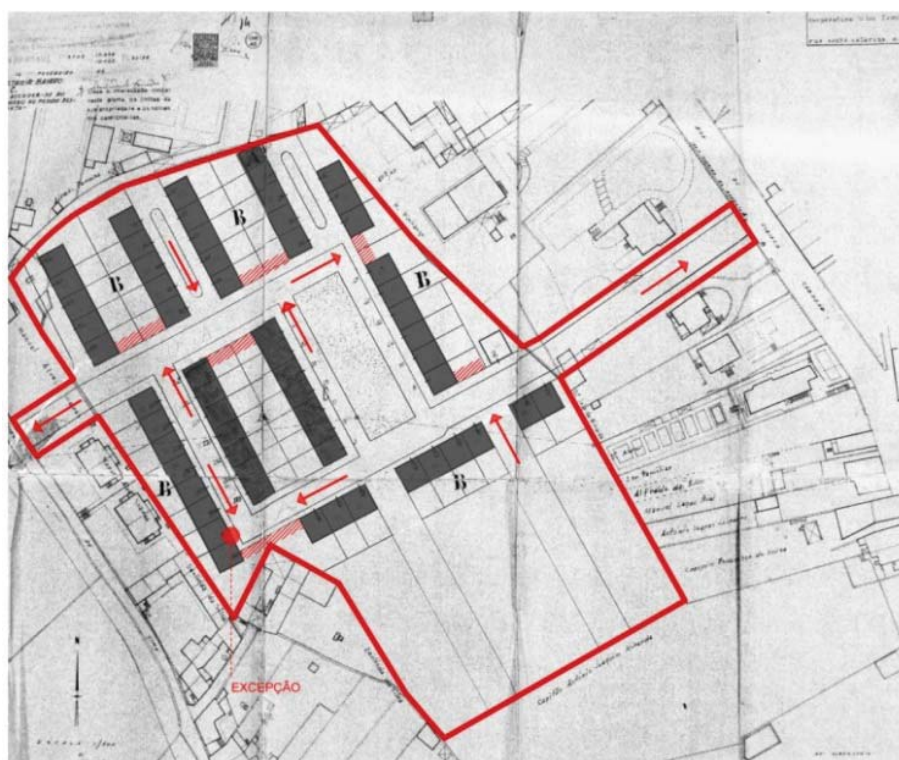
Esquema de aberturas visuais sobre planta topográfica com 1ª fase – Janeiro de 1954
